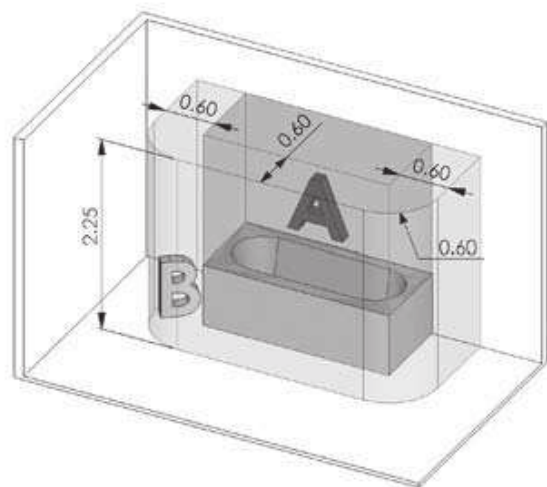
Zona de instalación / A : Volumen estructura / B : Volumen de protección
